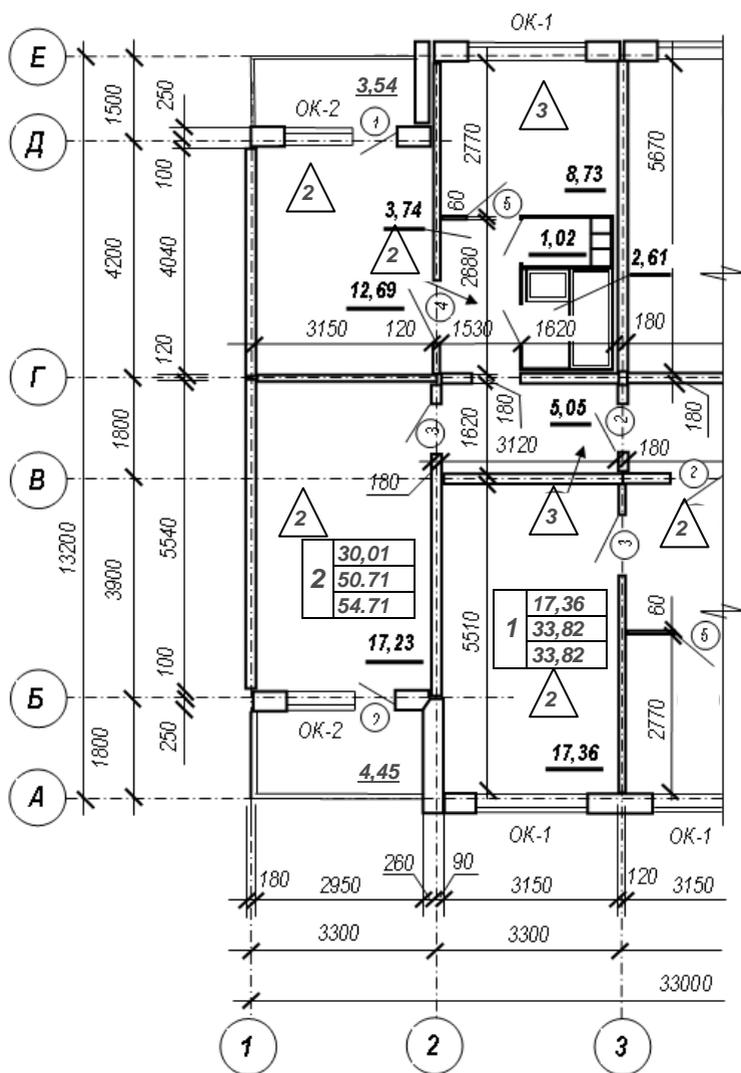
Пример оформления плана этажа жилого дома со стенами из крупных панелей
